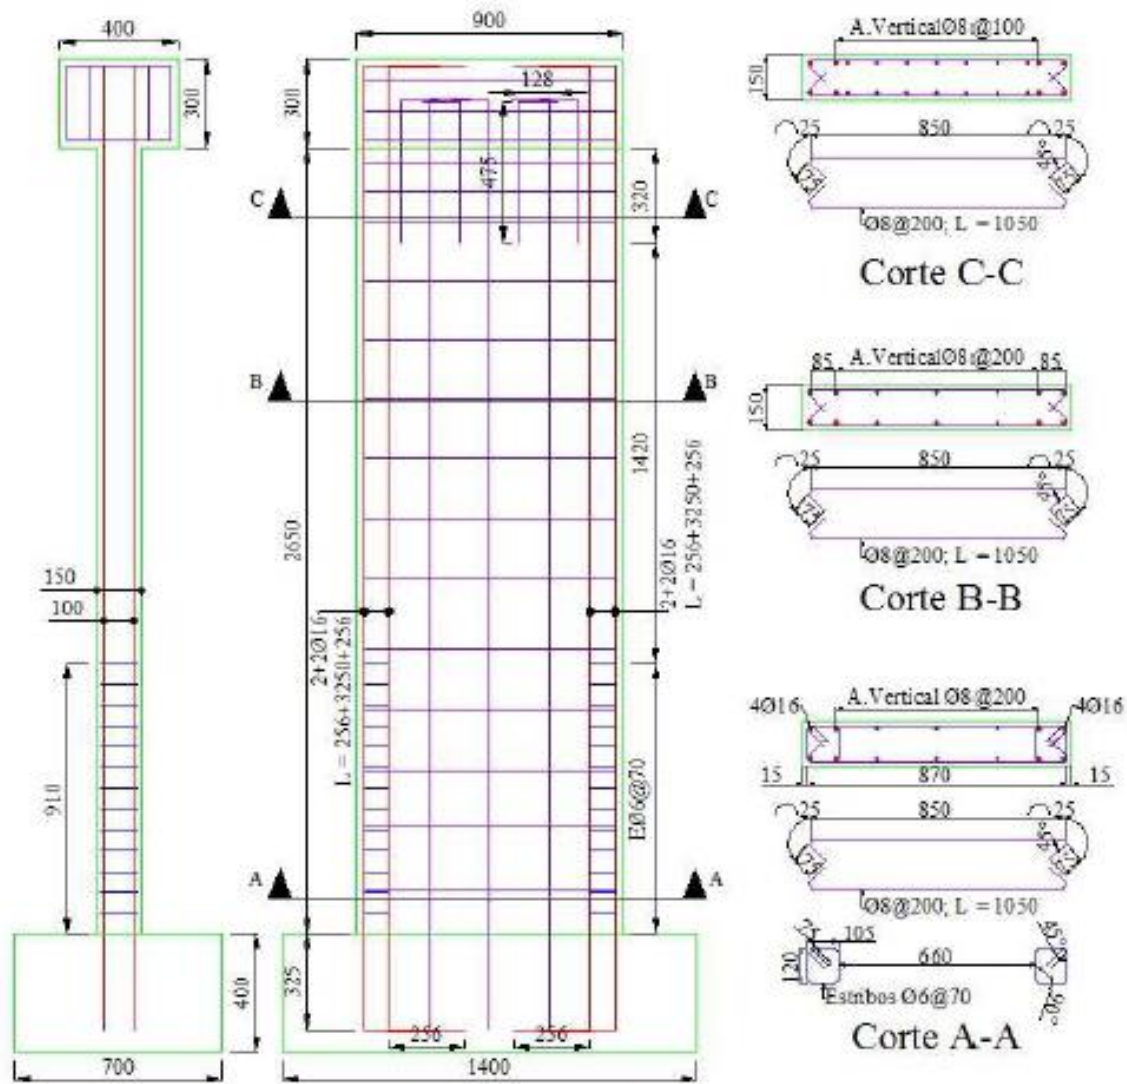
Detallamiento de armadura del muro base (Manríquez I., 2016).
